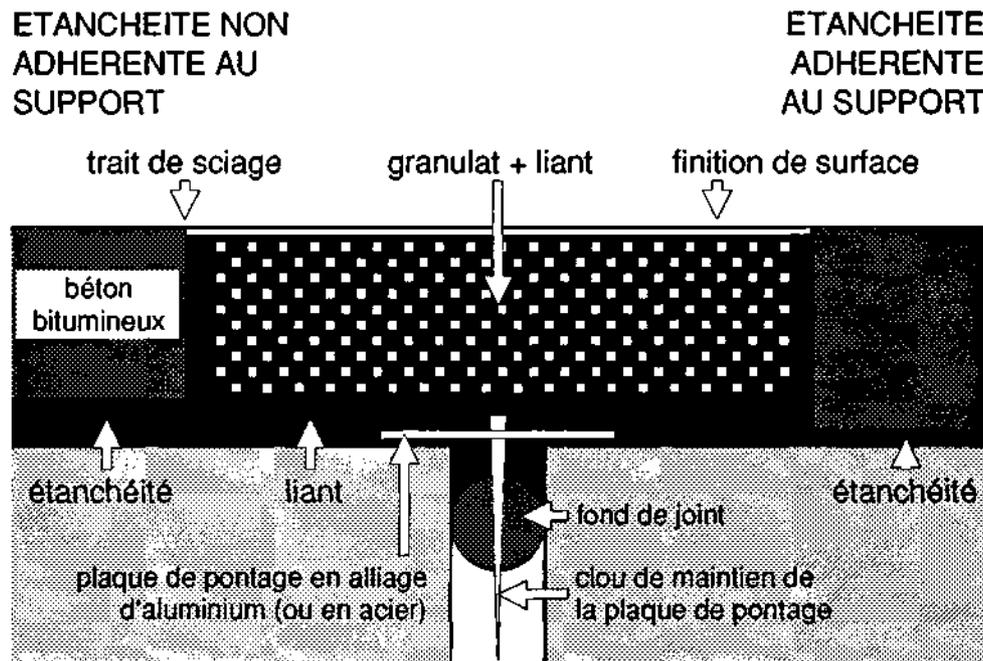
Détail du joint de chaussée étanche (procédé breveté)
